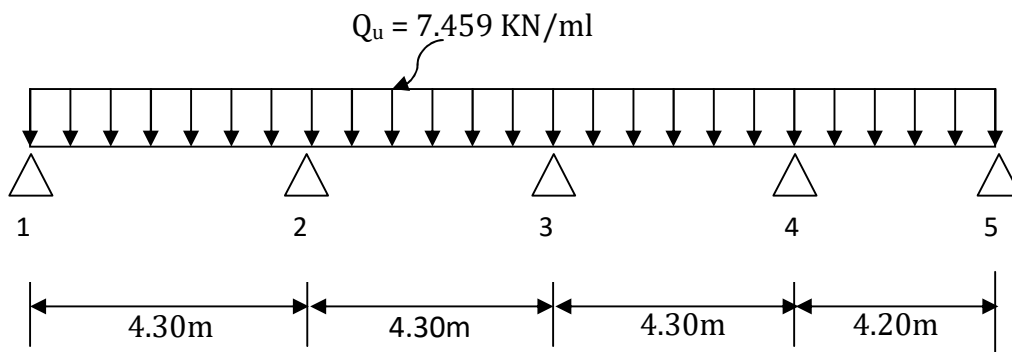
Schéma statique de calcul du 1er type de poutrelles
